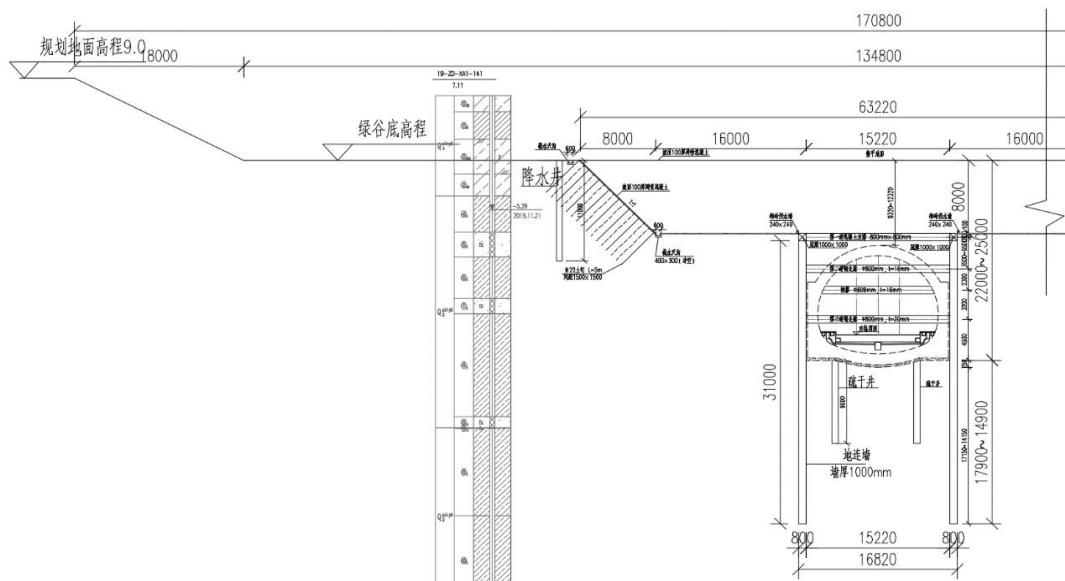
深基坑放坡+钻孔桩+内支撑形式典型横断面示意图
